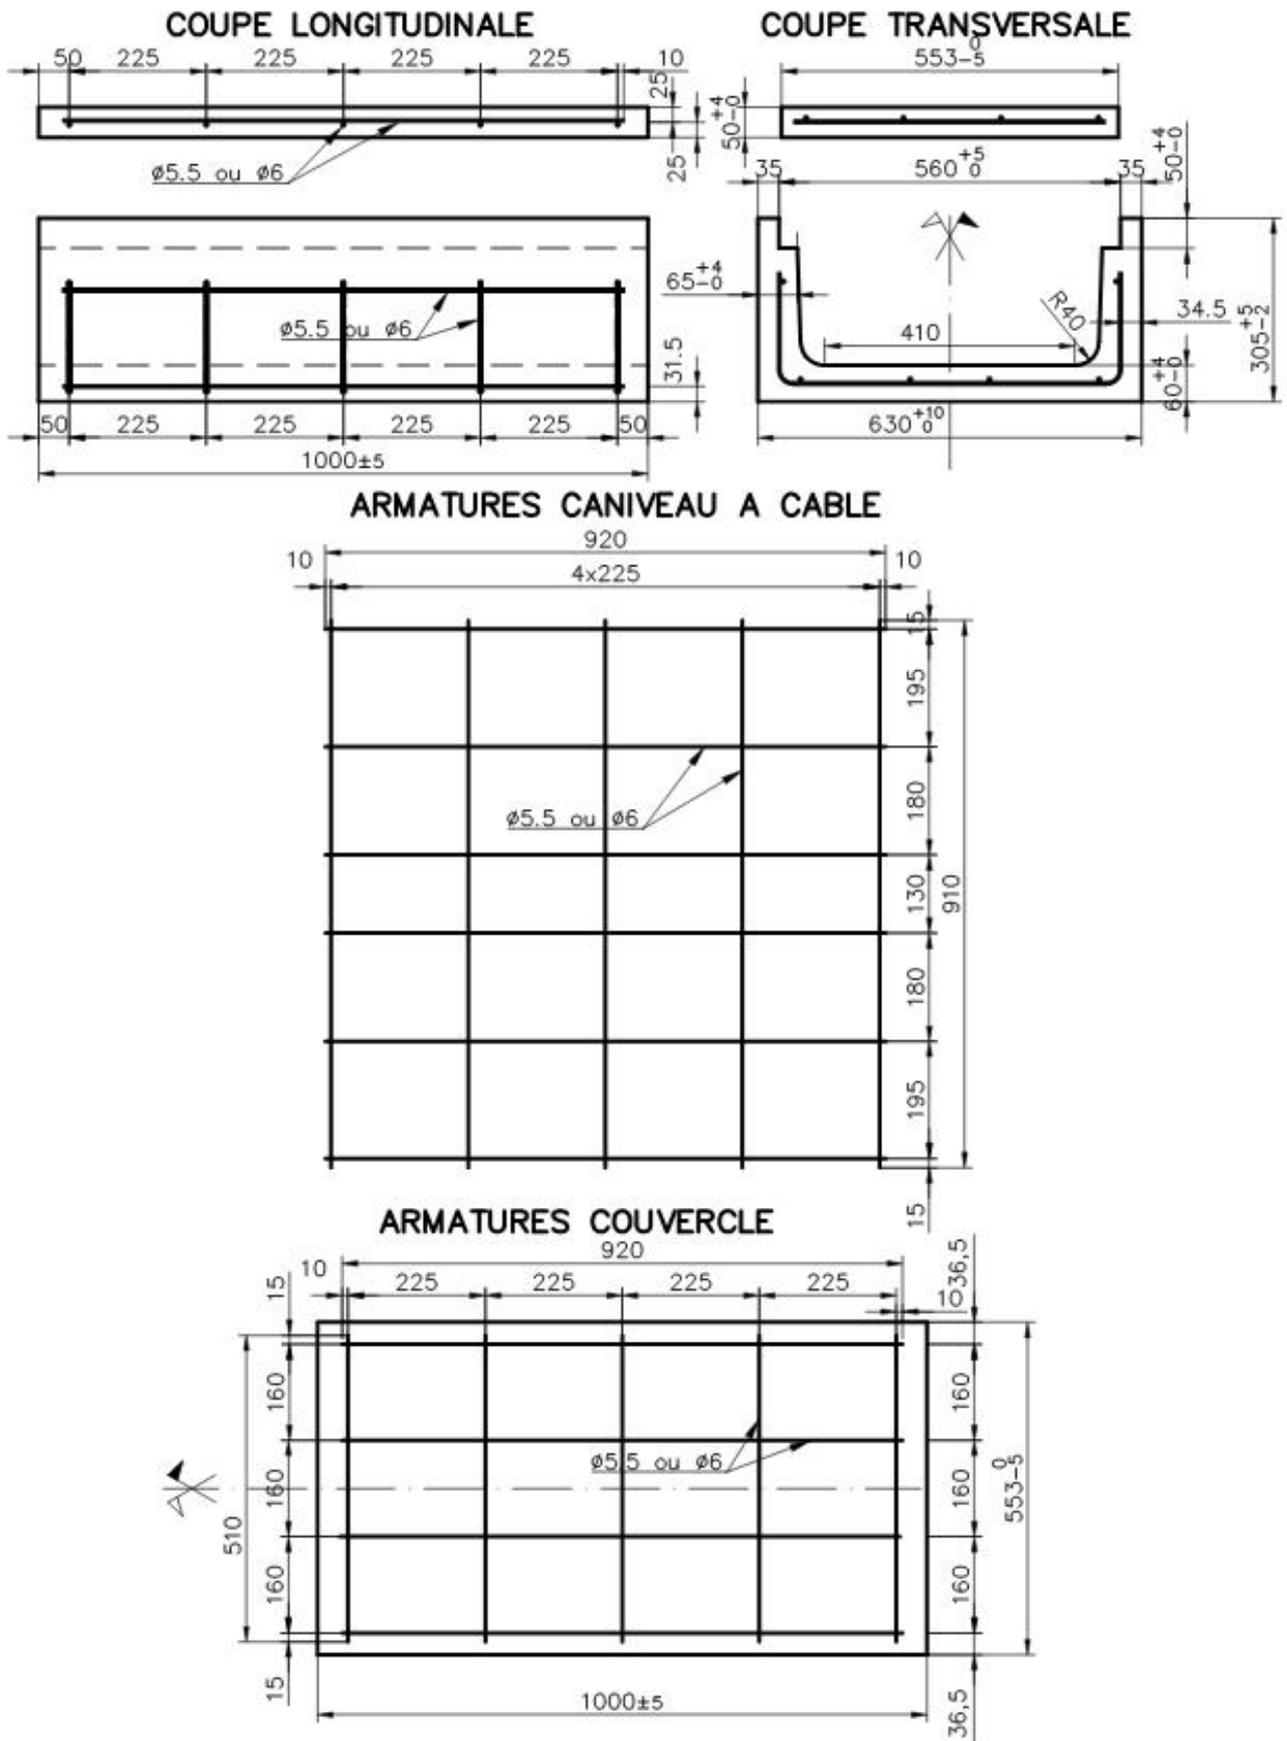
caniveau à câbles standard modèle 50 avec couvercle encastré (dimensions en mm)
